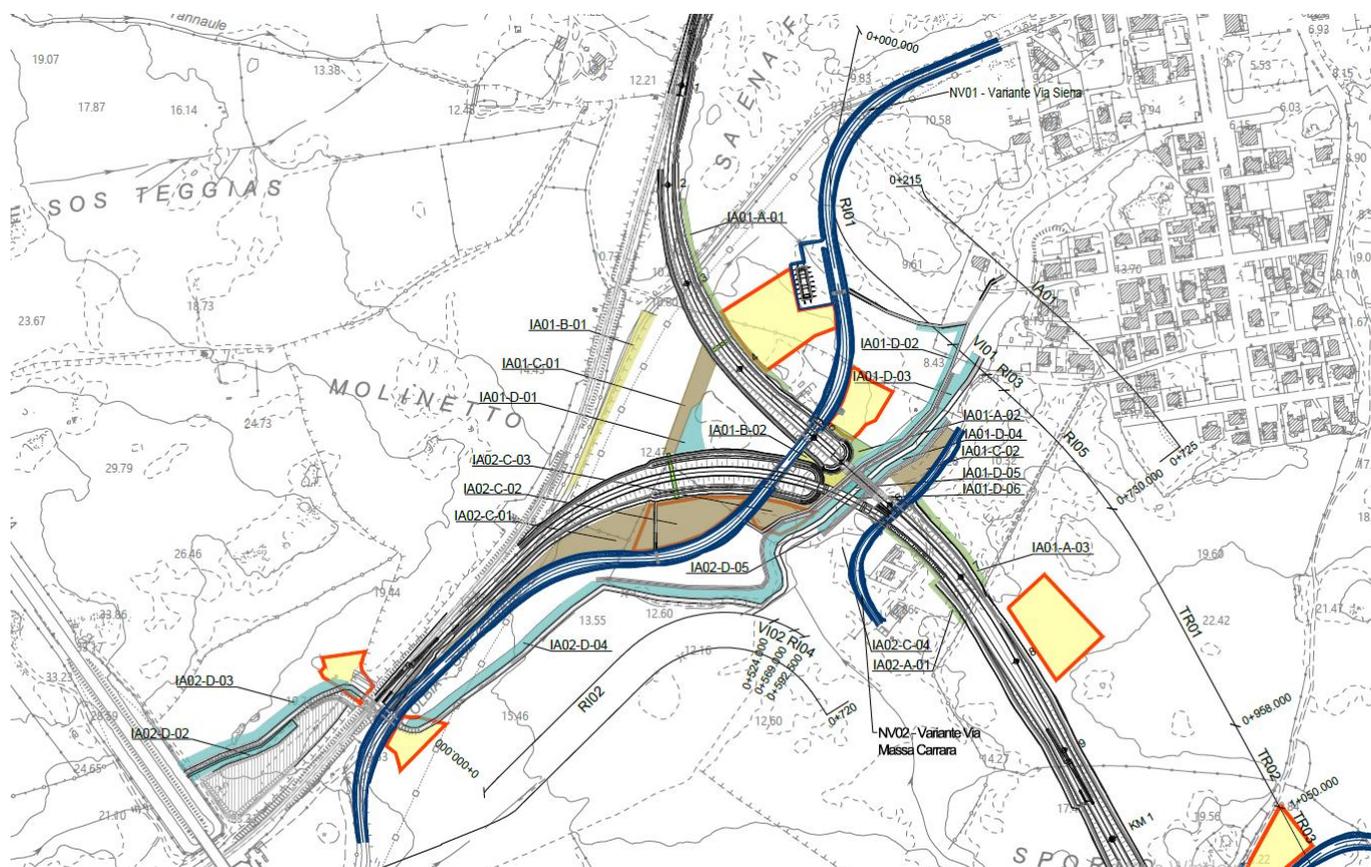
Stralcio della tavola Planimetria degli interventi di mitigazione
